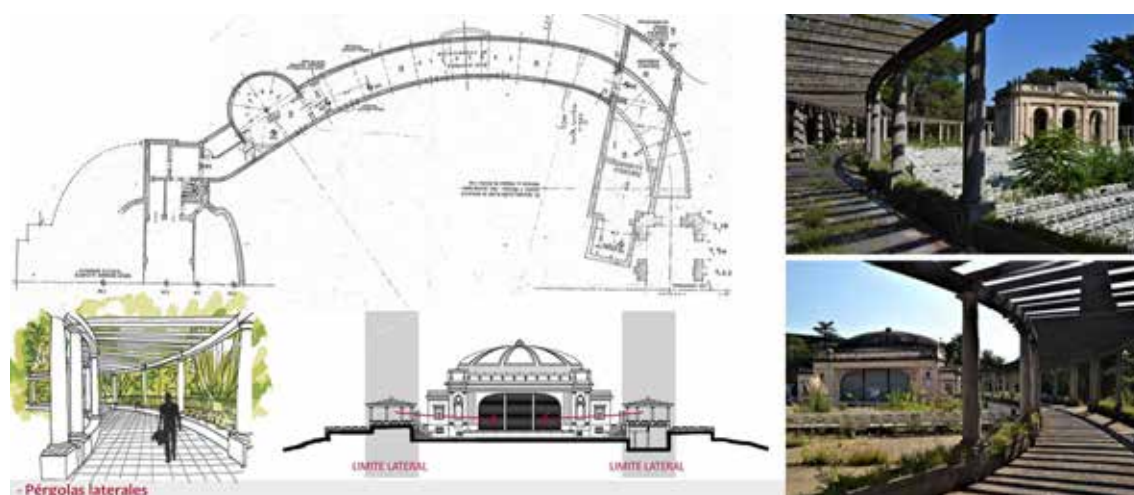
Pérgolas laterales. Fuente: Elaboración propia. Imágenes tomadas en marzo de 2020. Plano de planta facilitado por el Archivo del Ministerio de Infraestructura de la Prov. de Bs.As.
